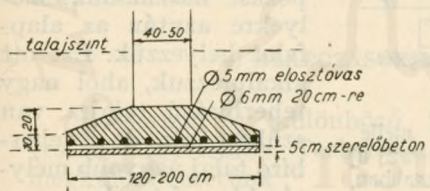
ábra. Beton alapjal szélesítése laza talaj alapoásnál
